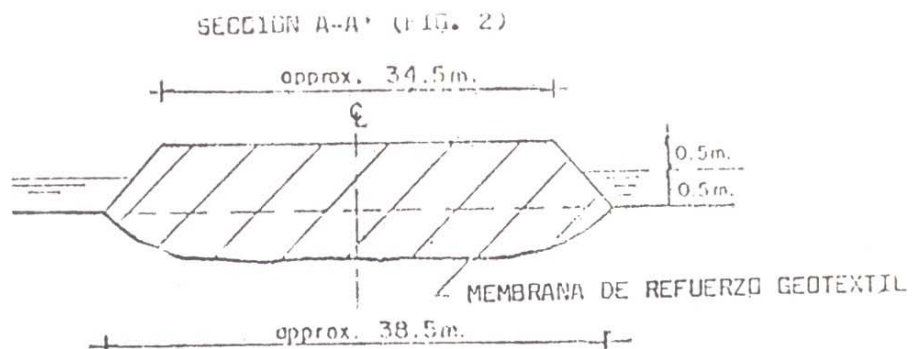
CONSTRUCCION DE PLANTILLA DE TRABAJO
